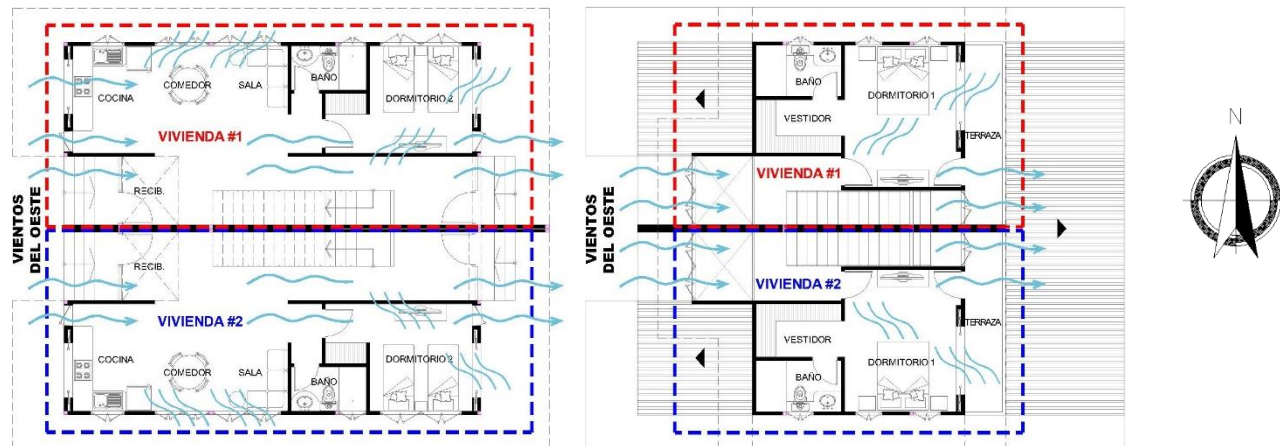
Disposición rectangular de los módulos y ventilación cruzada en planta baja y planta alta. Elaboración Propia.
